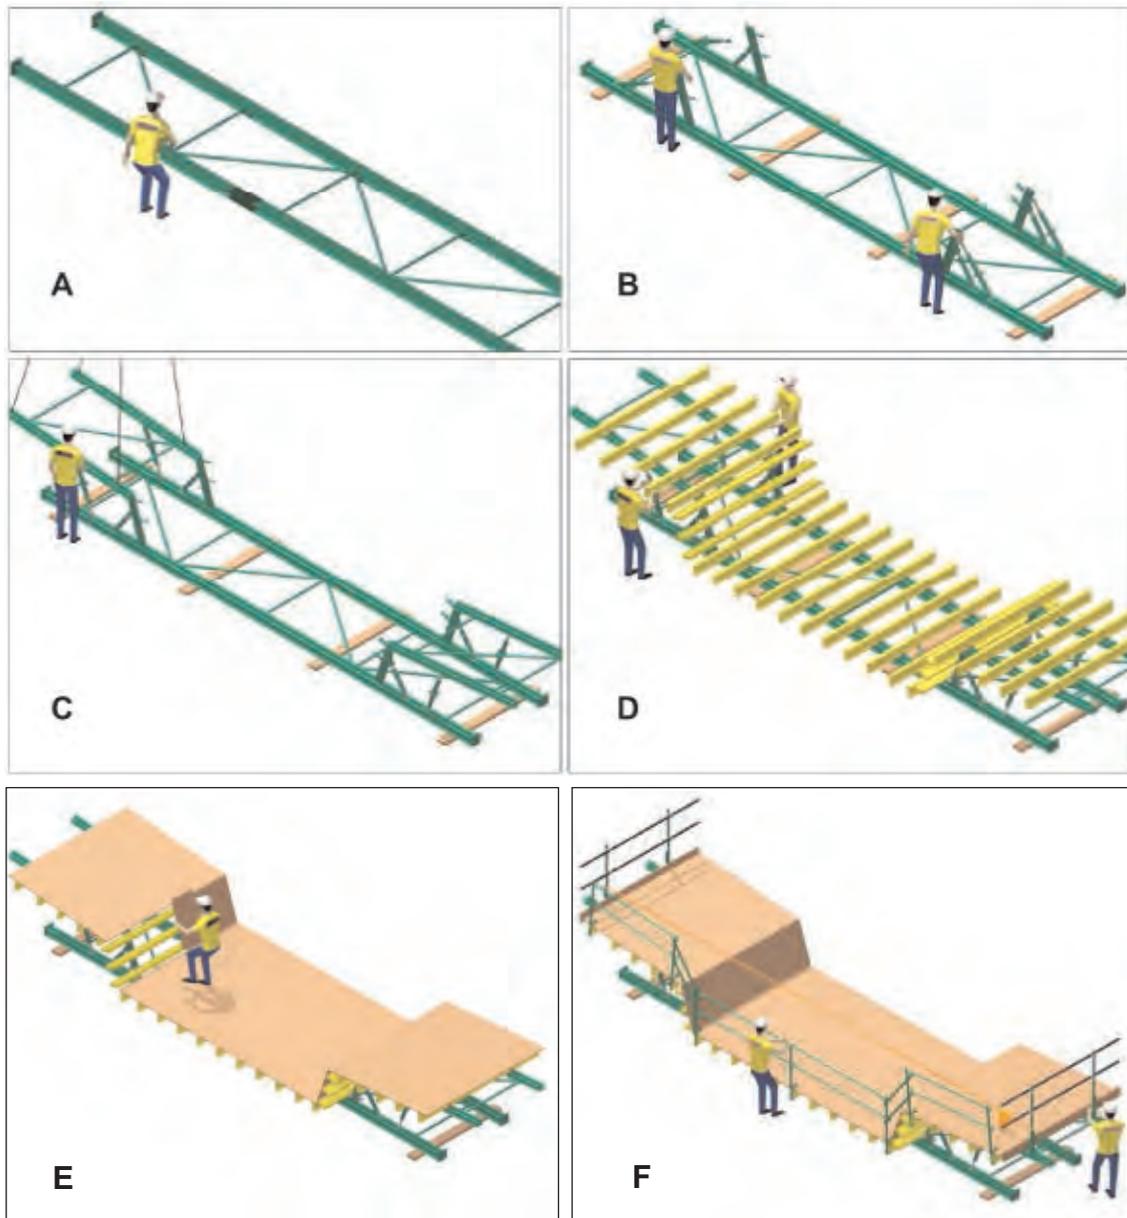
Montaje de encofrado tipo barco. Fases A, B, C, D, E y F
